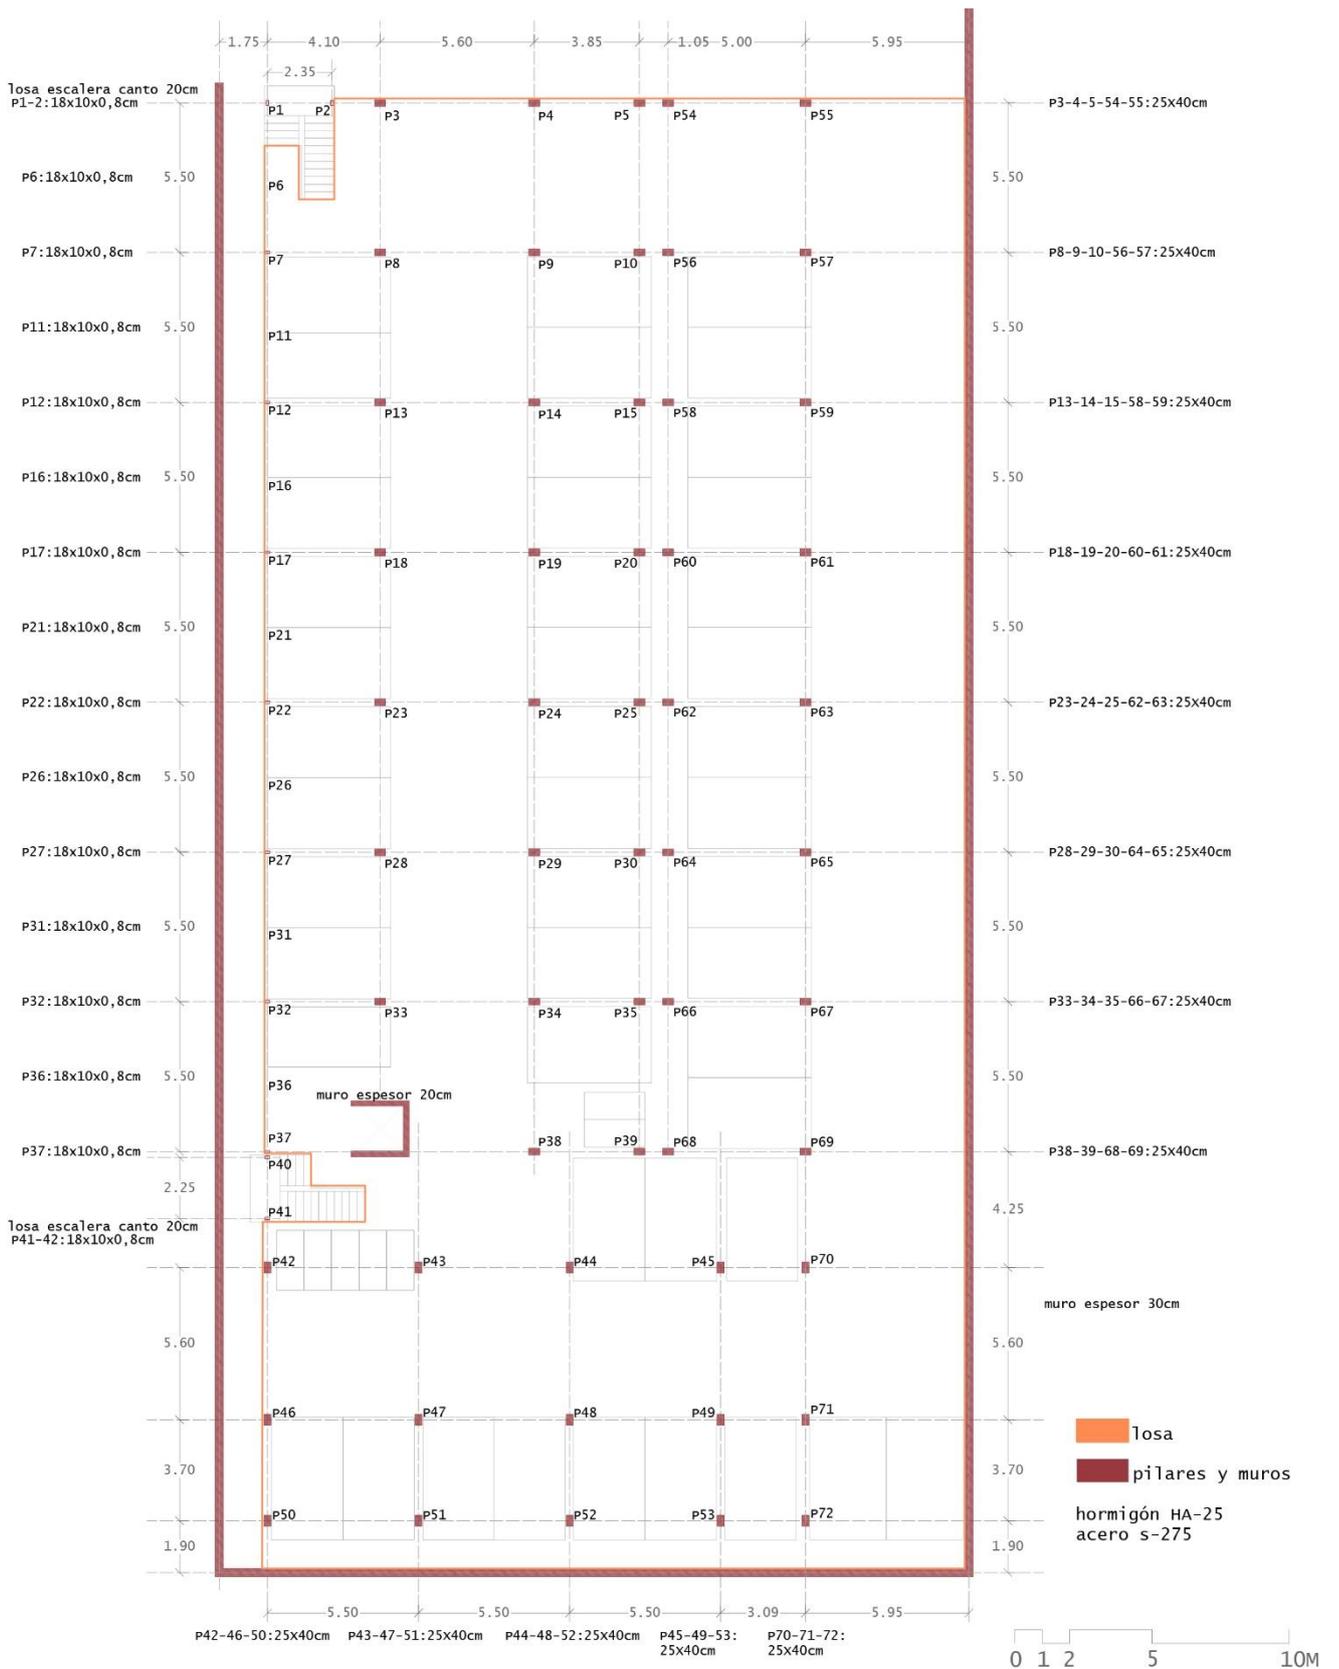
Planta estructural del forjado 1 (Modelo 1)
